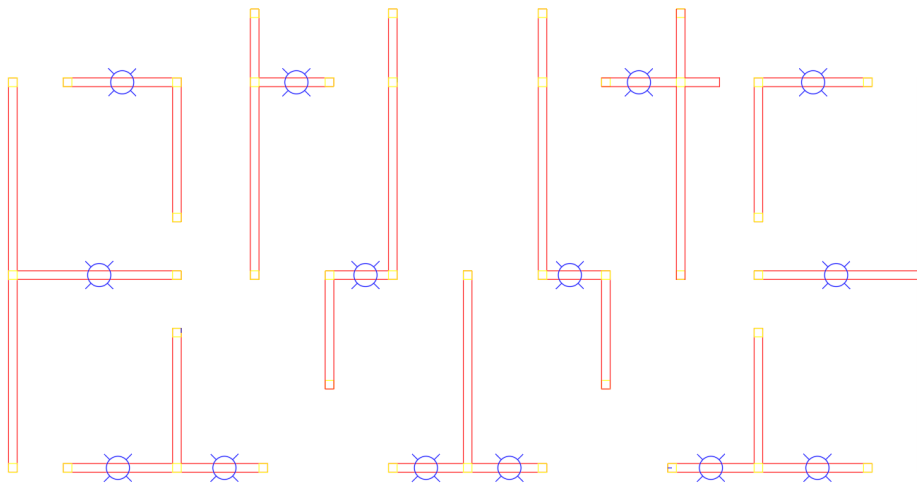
Ubicación de centro de columnas anchas en la dirección X.
